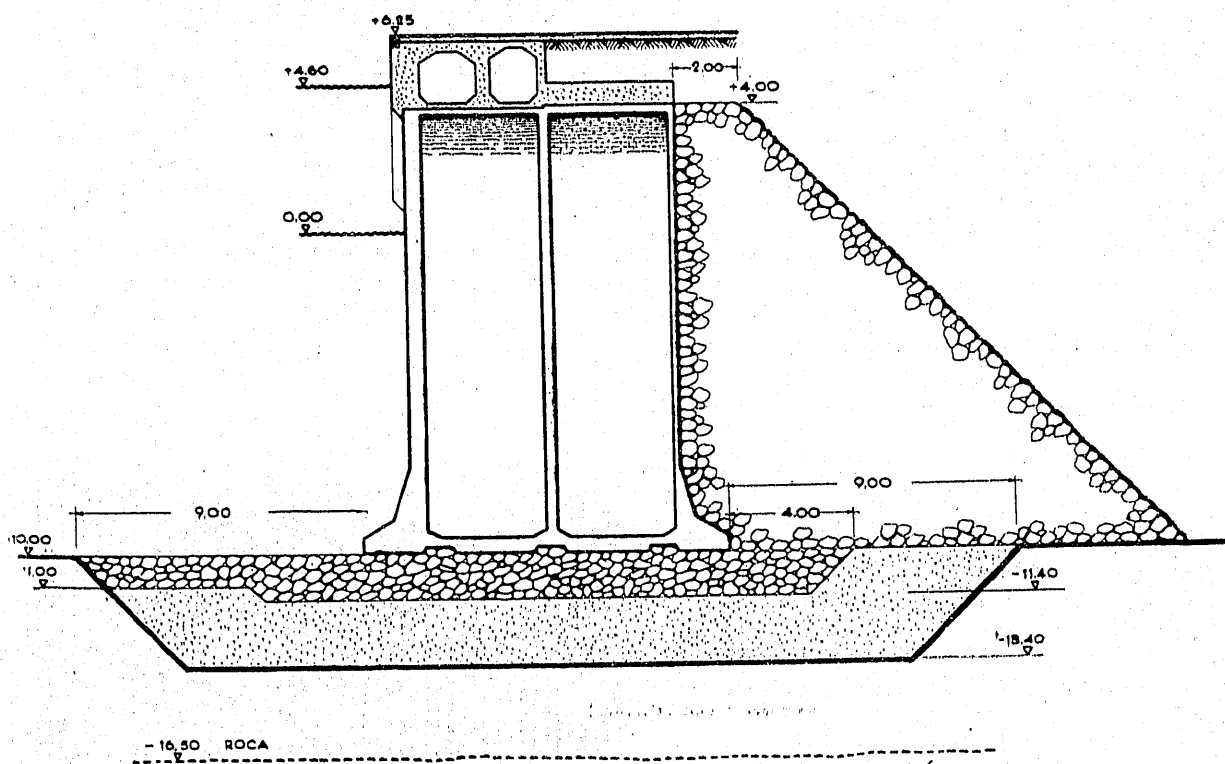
"— Sección tipo del muelle, constituido por cajones de hormigón armado, fondeados sobre arena y escollera.
